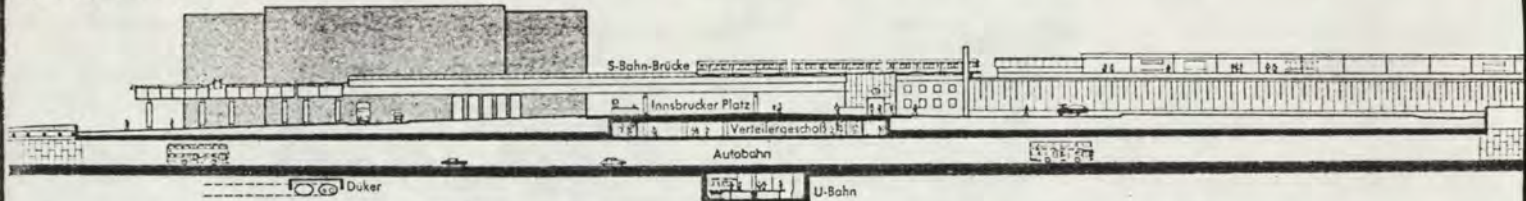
Schnitt durch den Autobahntunnel (A—A)
